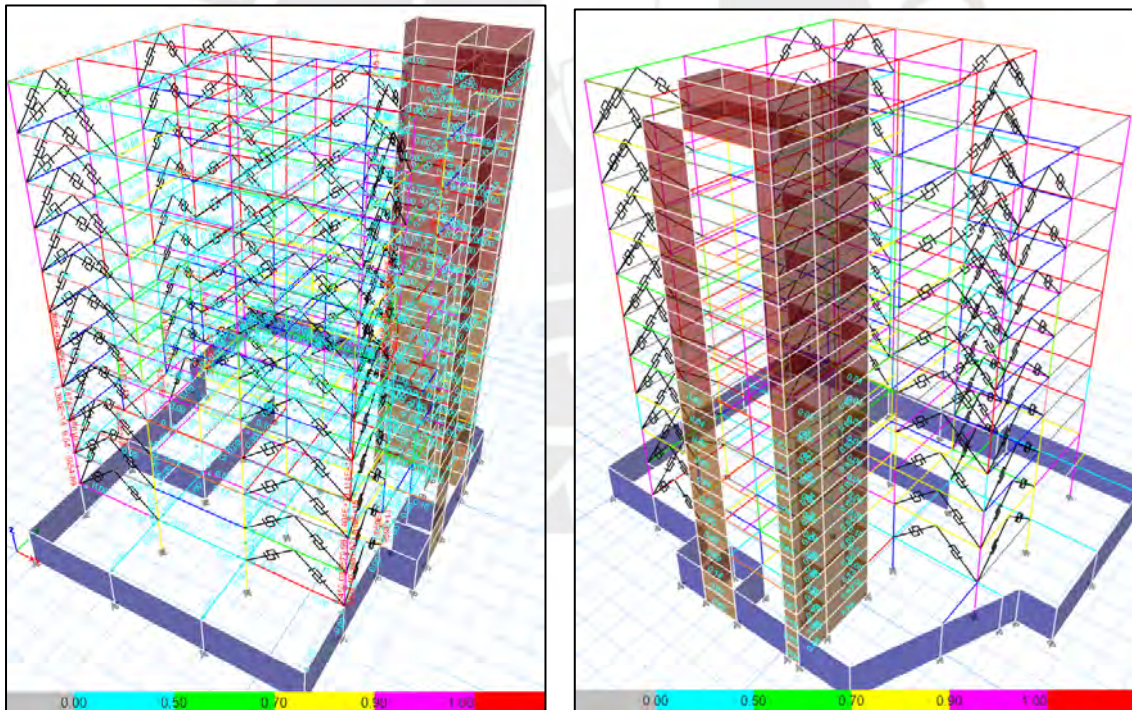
Imágenes de las vigas, columnas y placas para Prevención de Colapso
